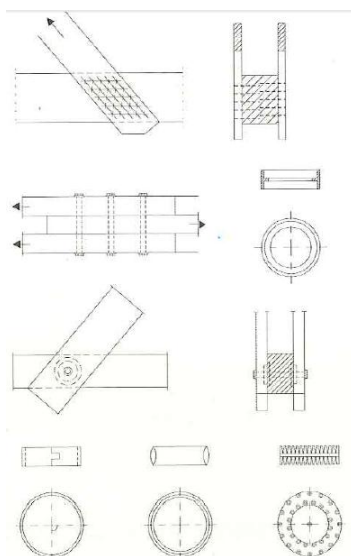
Exemplos de pregagem e anéis de penetração nas ligações em asna de madeira. [2]
